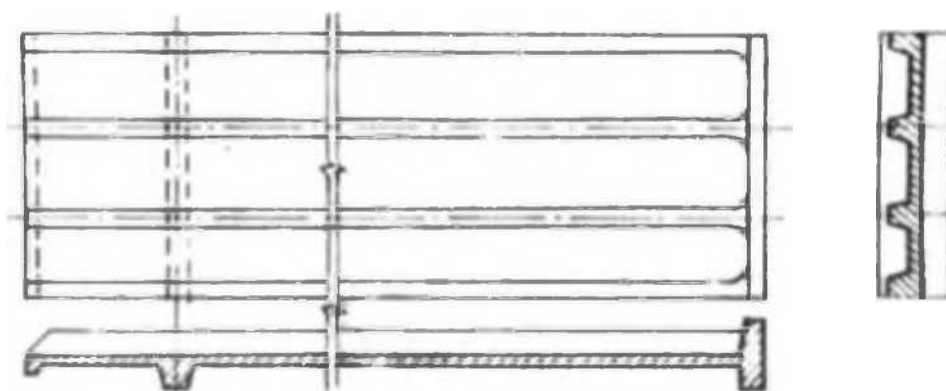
Пример кровельной плиты с полкой в растянутой зоне сечения для крыш с внутренним водоотводом
